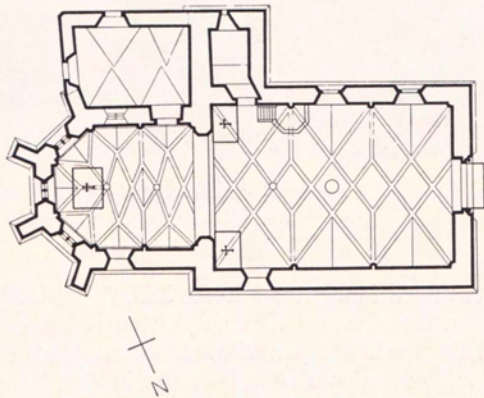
Grundriss. — Maßstab 1:300.
